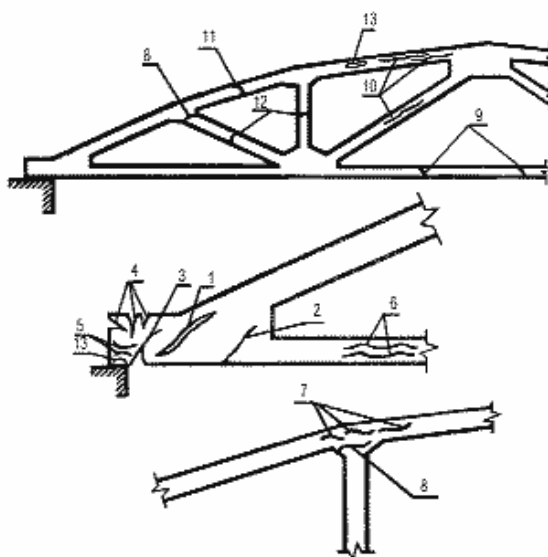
Картина трещинообразования в стропильной раскосной ферме. Наклонные трещины опорного узла: 1 — низкий класс бетона, недостаточное количество поперечной арматуры: большой шаг стержней, малый диаметр; 2 — недостаточное преднапряжение продольной арматуры, проскальзывание ее в зоне заанкеривания, недостаточное количество поперечной арматуры; 3 — нарушение анкеровки преднапряженной арматуры: низкий класс бетона, недостаточная прочность бетона на момент обжатия. Лучеобразные вертикальные трещины: 4 — недостаточное косвенное армирование от усилий обжатия преднапряженной арматуры. Горизонтальные трещины: 5 и 6 — отсутствие косвенного армирования (сетки, замкнутые хомуты) в зоне заанкеривания преднапряженной арматуры, низкая прочность бетона на момент обжатия, наклонные трещины в верхнем поясе; 7 — недостаточное косвенное армирование узла поперечными стержнями (сетками). Трещины, перпендикулярные оси элементов фермы: 8 — недостаточное заанкеривание рабочей арматуры растянутого элемента в узле фермы, слабое косвенное армирование узла; 9 — недостаточное преднапряжение нижнего пояса, перегрузка фермы. Продольные трещины в сжатых элементах: 10 — низкий класс бетона, перегрузка фермы. Монтажные трещины: 11 — изгиб из плоскости фермы при монтаже, перевозке, складировании. Нормальные трещины в растянутых элементах: 12 — перегрузка фермы, смещение арматурного каркаса относительно продольной оси элемента; 13 — откол лещадок.
